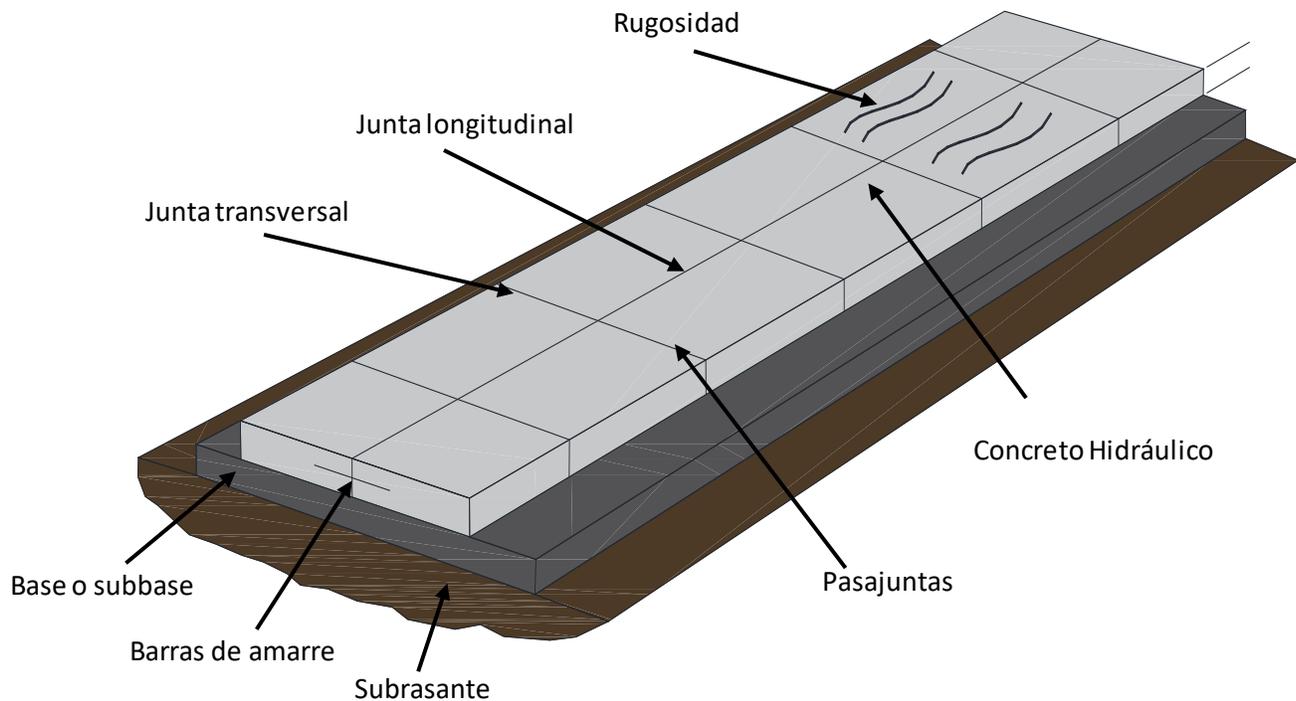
Elementos de un pavimento de concreto con juntas. (Elaboración propia).
